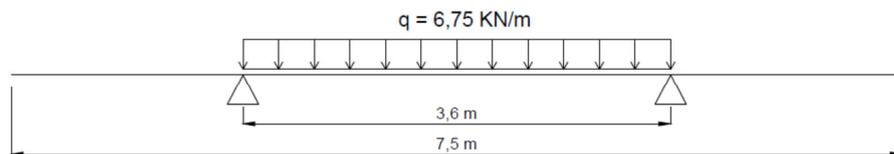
Viga teórica para el cálculo de las vigas transversales apoyadas sobre las vigas Tensairity®. Momento flector máximo
